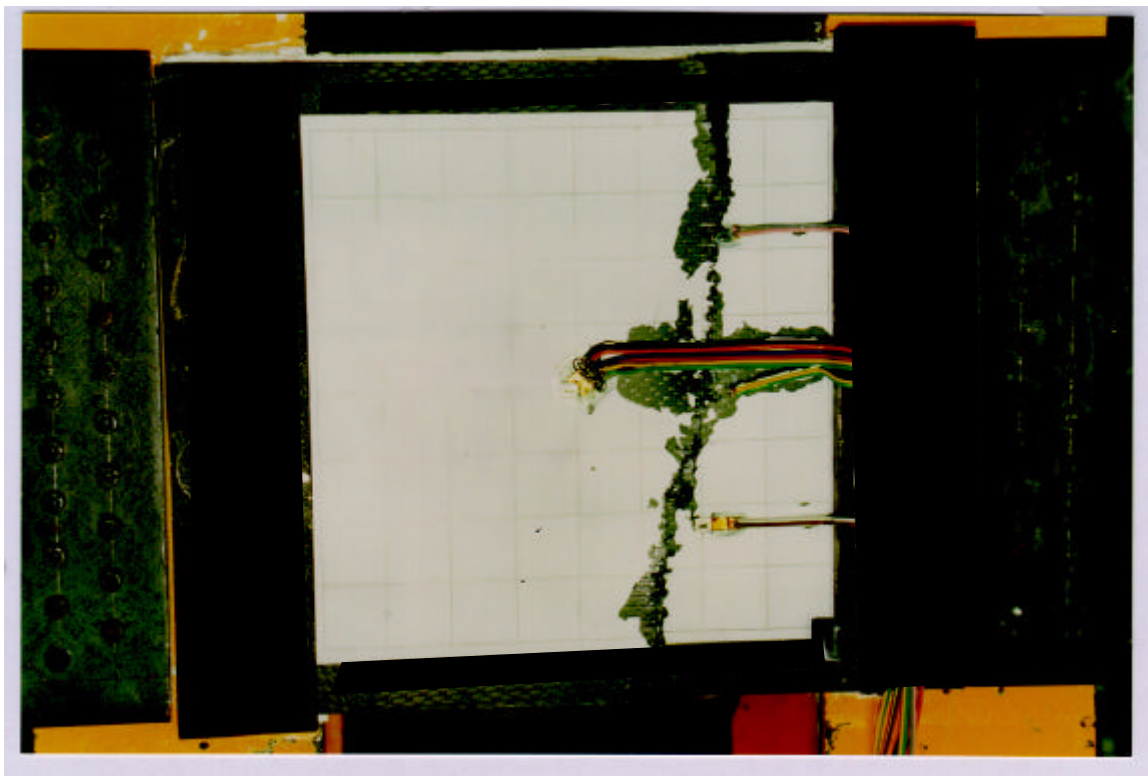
Rupture de la deuxième éprouvette en compression (photo sur le montage)
